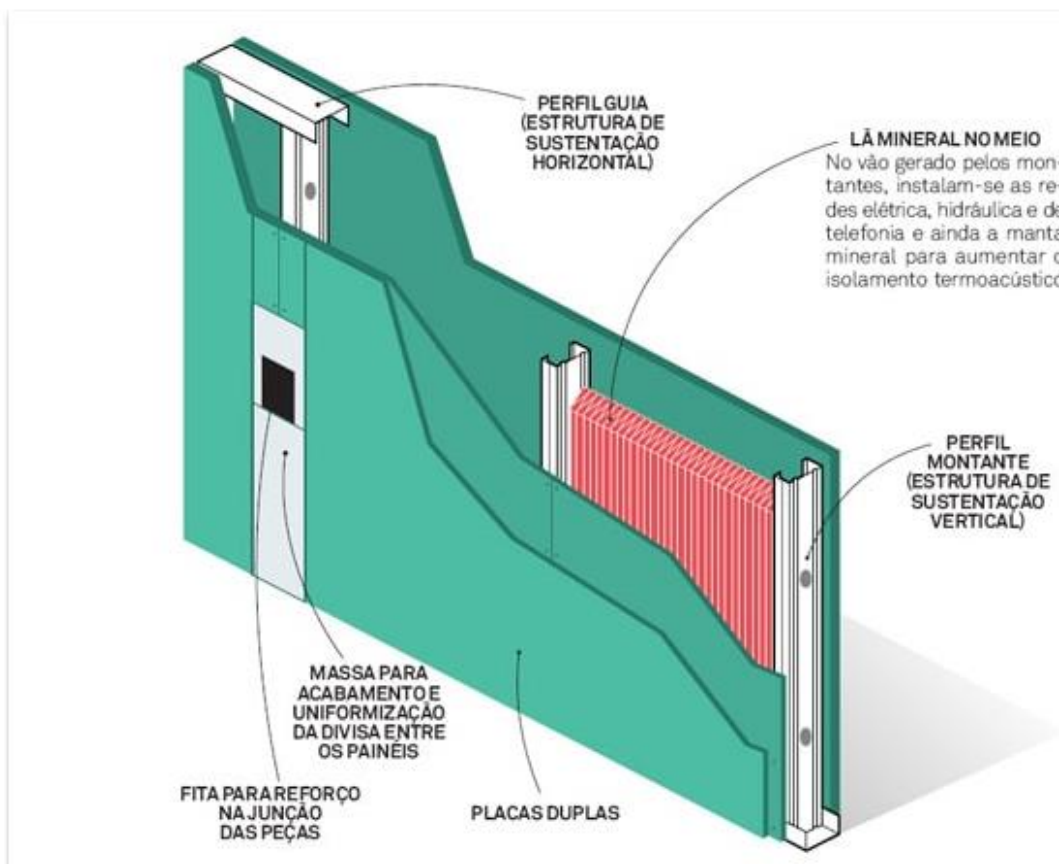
Esquema drywall, Fonte: Casacor 2020
